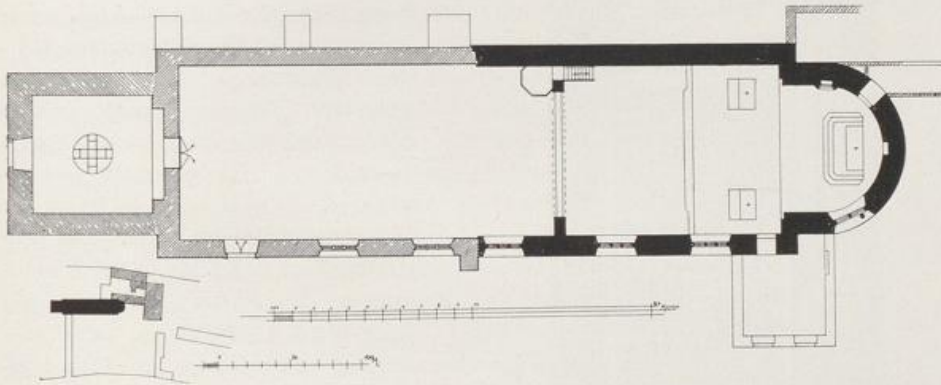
Bürvenich. Grundriss der kath. Pfarrkirche.
